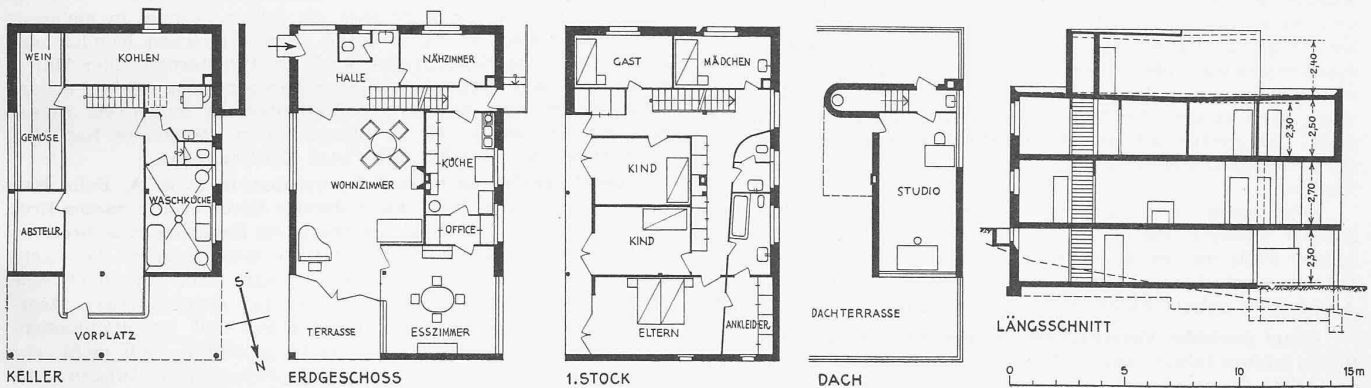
bis 5. Haus eines Wissenschafters in Basel-Binningen. Grundrisse und Schnitt 1:300.
